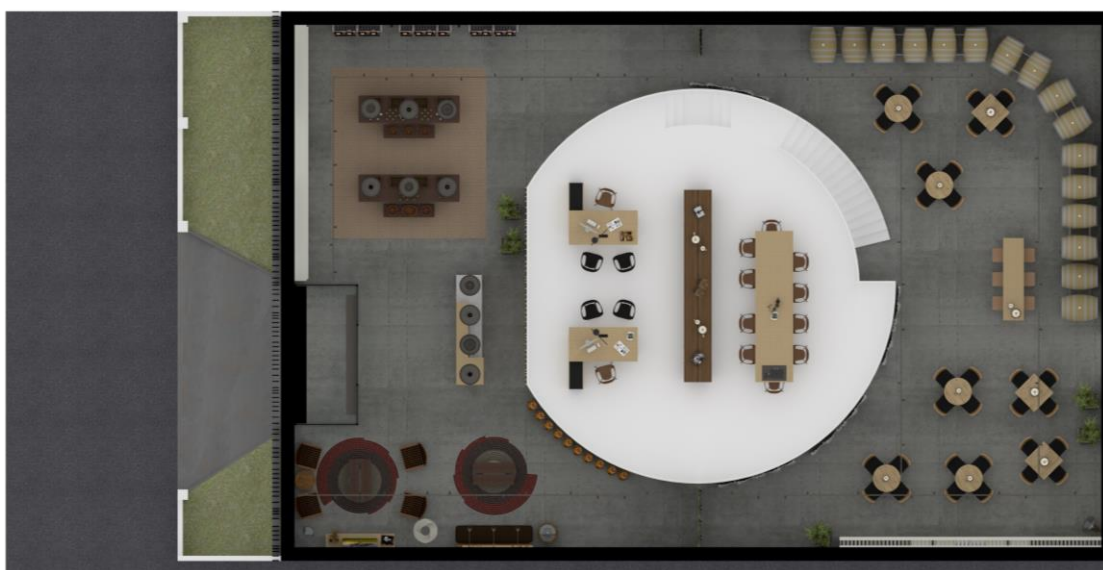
Visualização 3D - Planta (Mezzanine). Fonte: (Autor)
